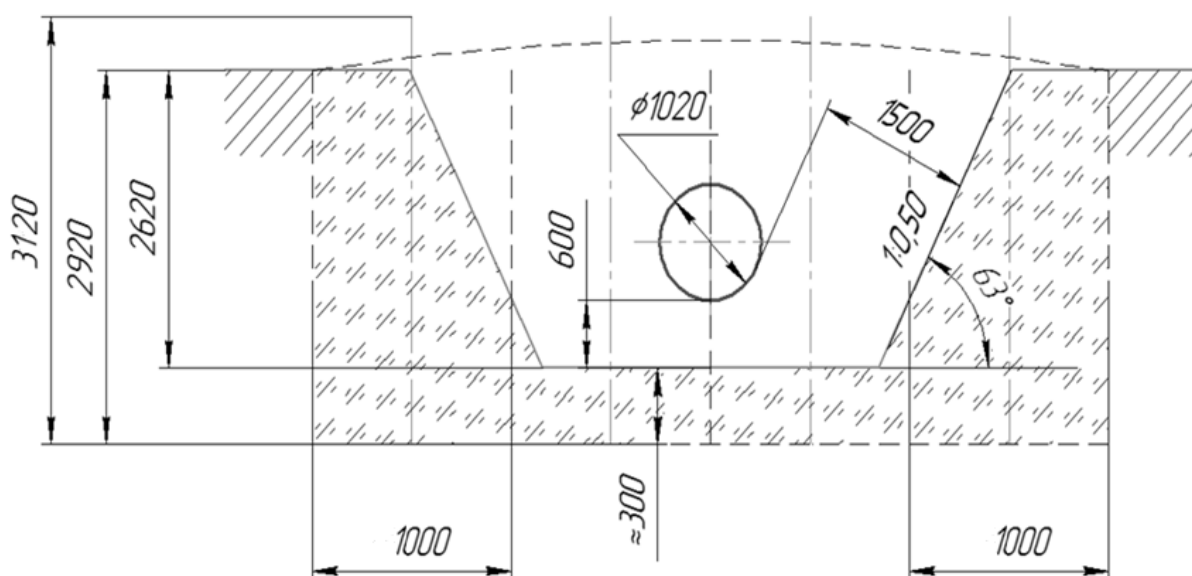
Поперечный разрез котлована и ледогрунтового ограждения при вырезке катушки диаметром 1020 мм
